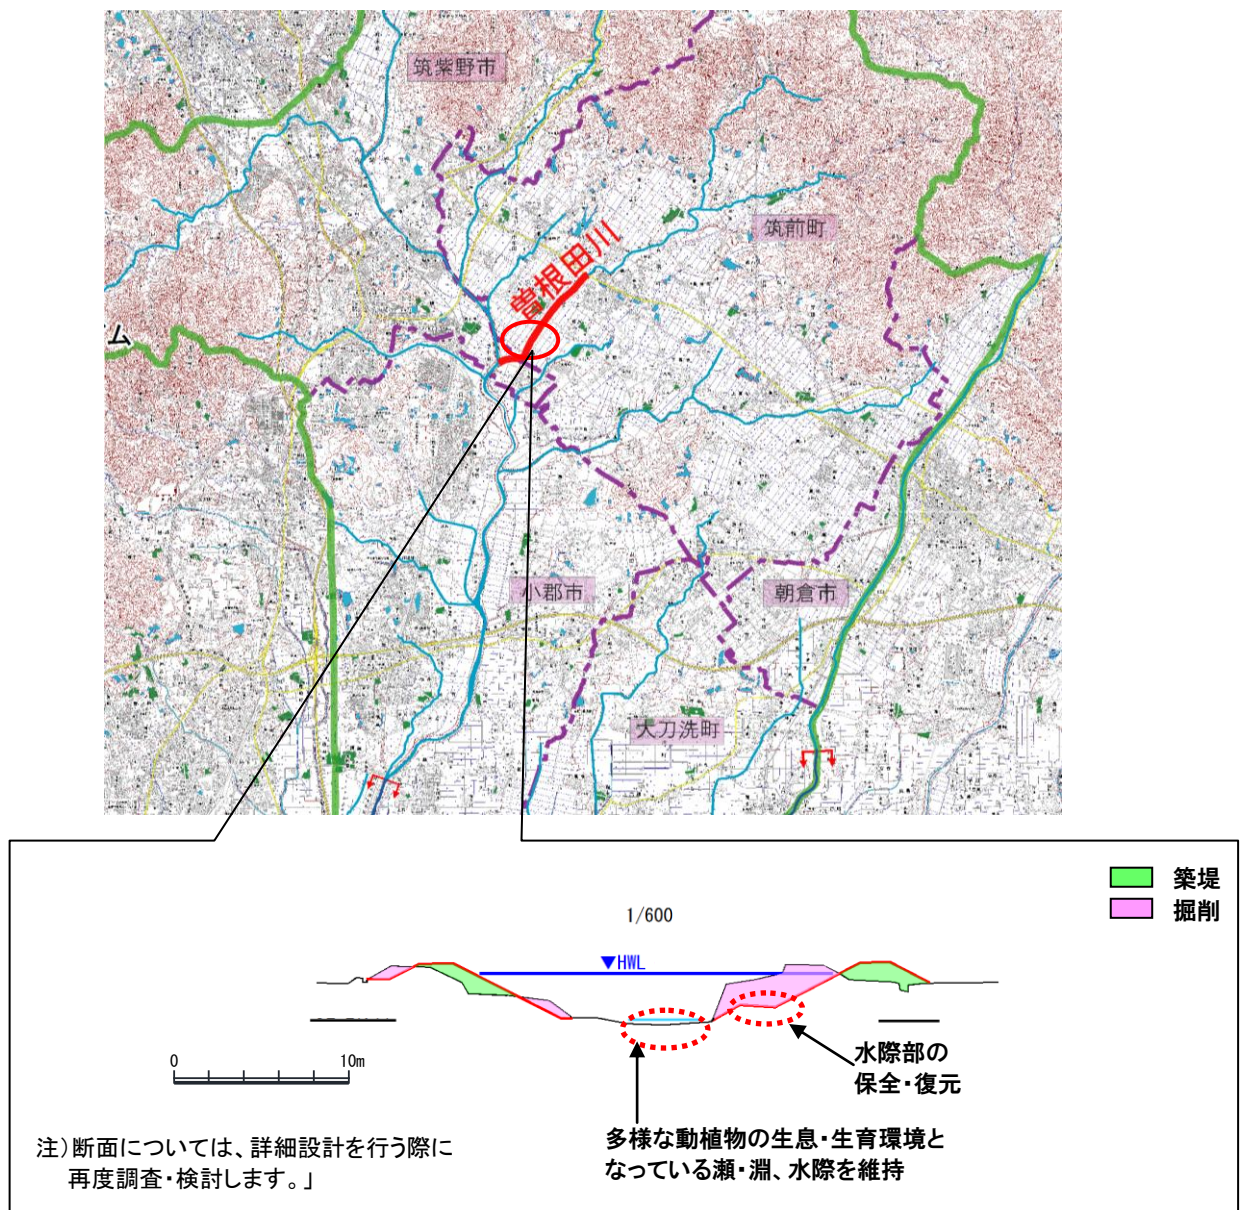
曾根田川 整備計画区間平面図・代表横断図
